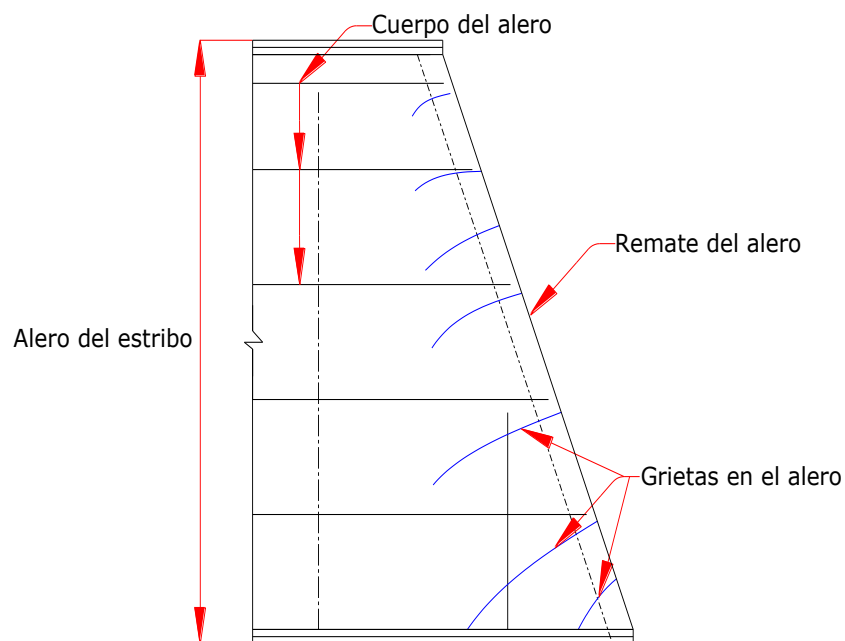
Agrietamiento que se presenta en el cuerpo de los aleros del estribo.
